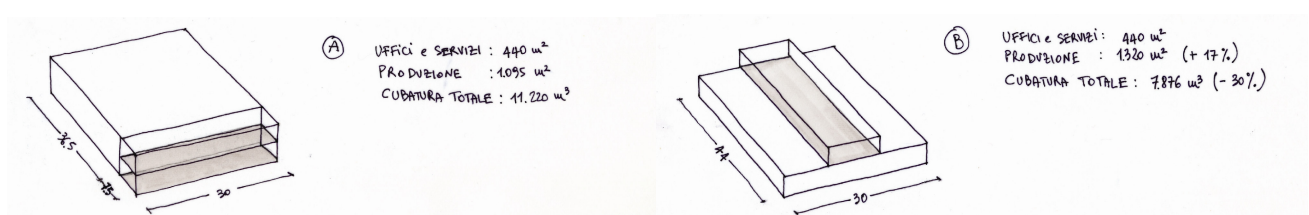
Layout distributivi: A) soluzione tradizionale B) soluzione Omnes
